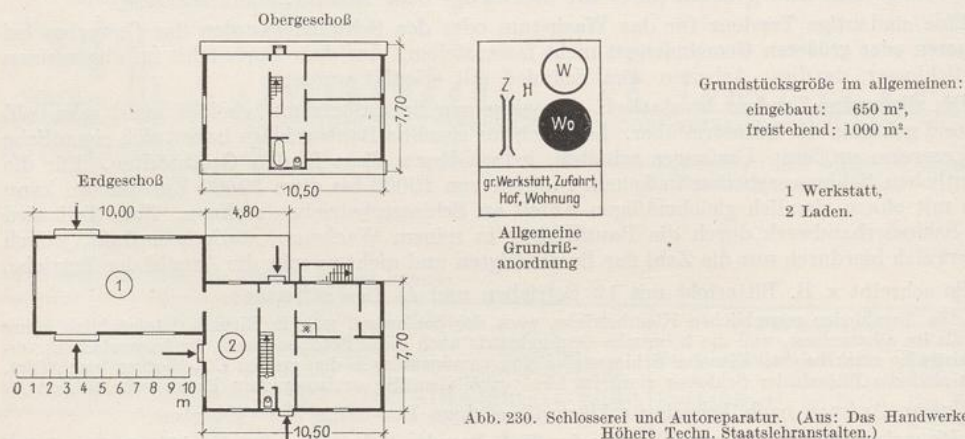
Schlosserei und Autoreparatur. (Aus: Das Handwerkerhaus. Höhere Techn. Staatslehranstalten.)
